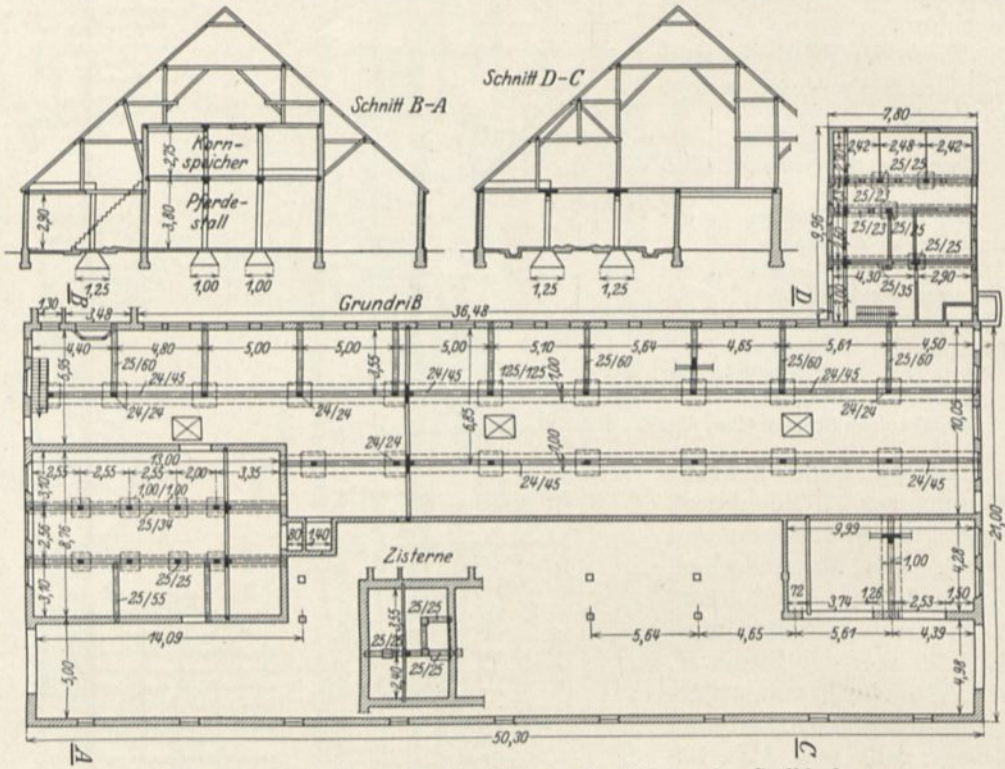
Stallgebäude in Connhausen. Ausbildung der Stalldecke.
